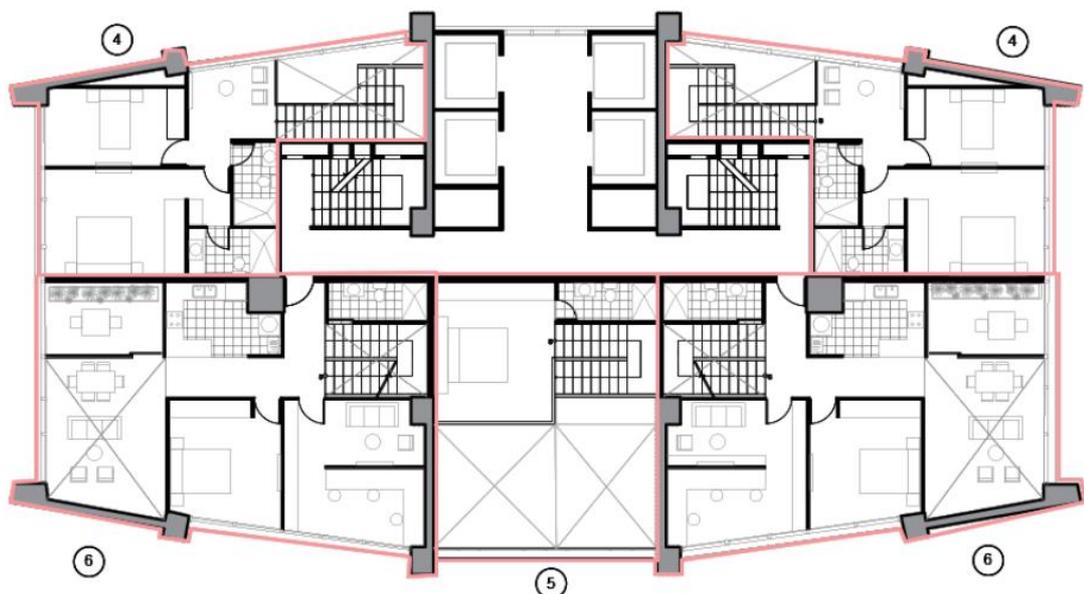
PLANTA TIPO 2. Elaboración Propia.
